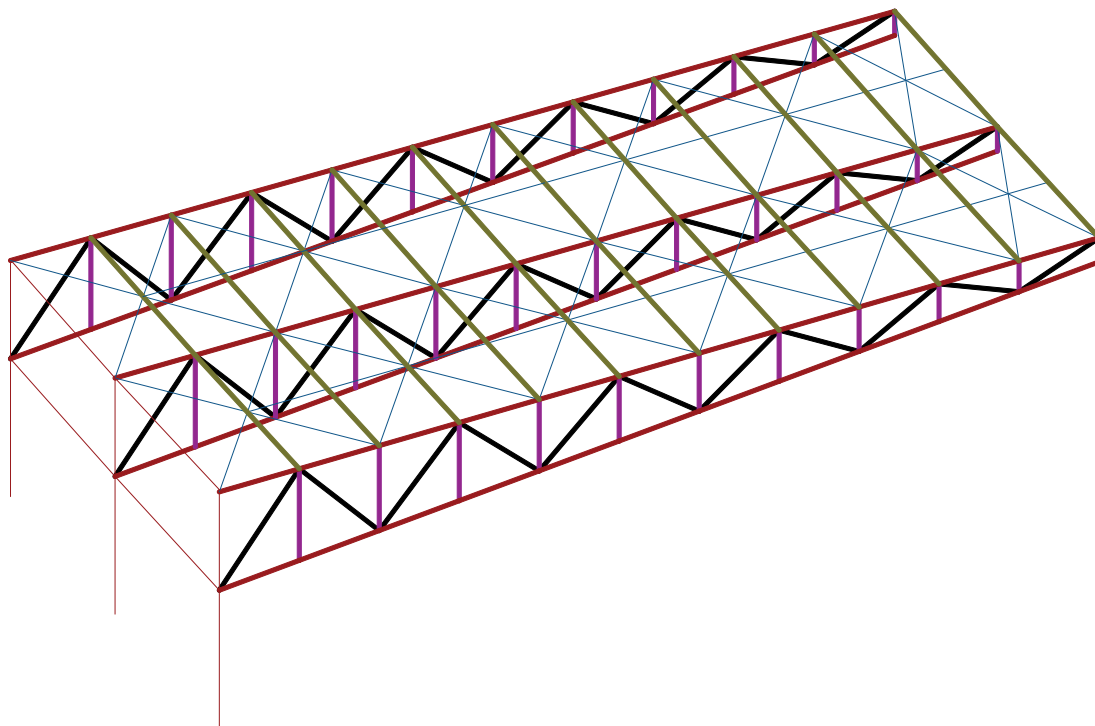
Vista tridimensional de la Estructura Metálica
